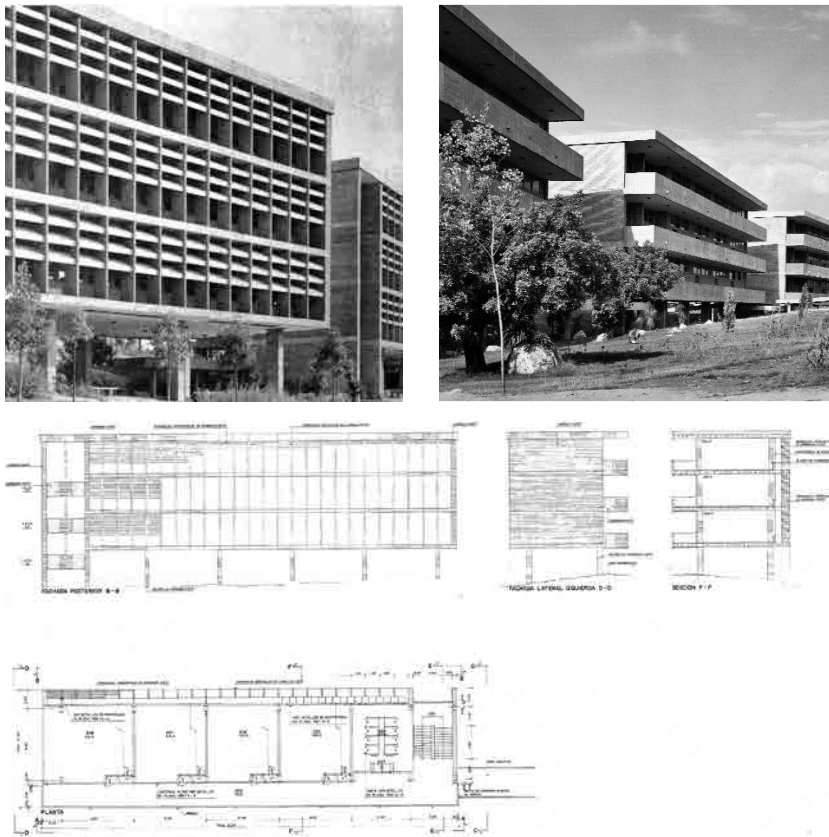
, Fig. 63, Fig. 64, Fig. 65, Fig. 66 y Fig. 67 Aularios. Vista de la fachada Sur (arriba izquierda, fotografía de época), vista de la fachada Norte (arriba derecha, fotografía de época), alzado Sur (centro izquierda), alzado Oeste y sección por las aulas (centro derecha) y planta tipo de aulas (abajo).
